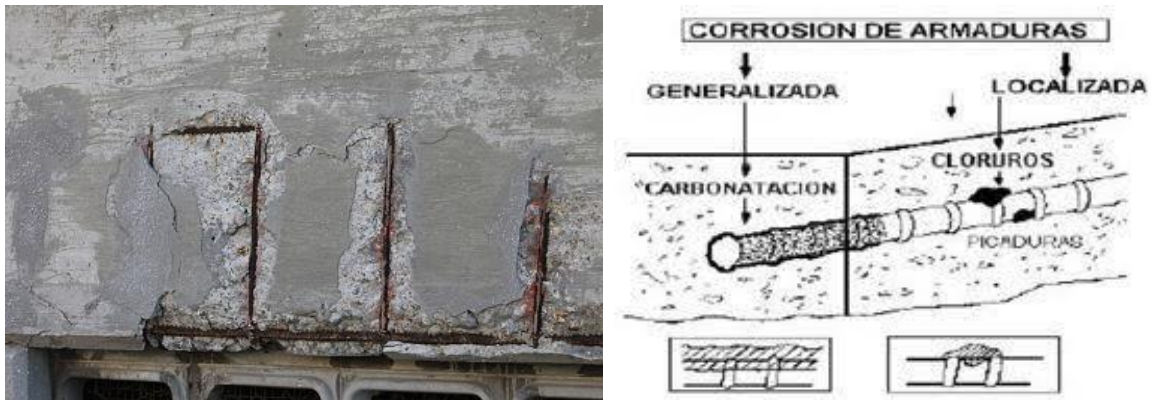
Vigas de Hormigon Armado, daños por corrosión.
